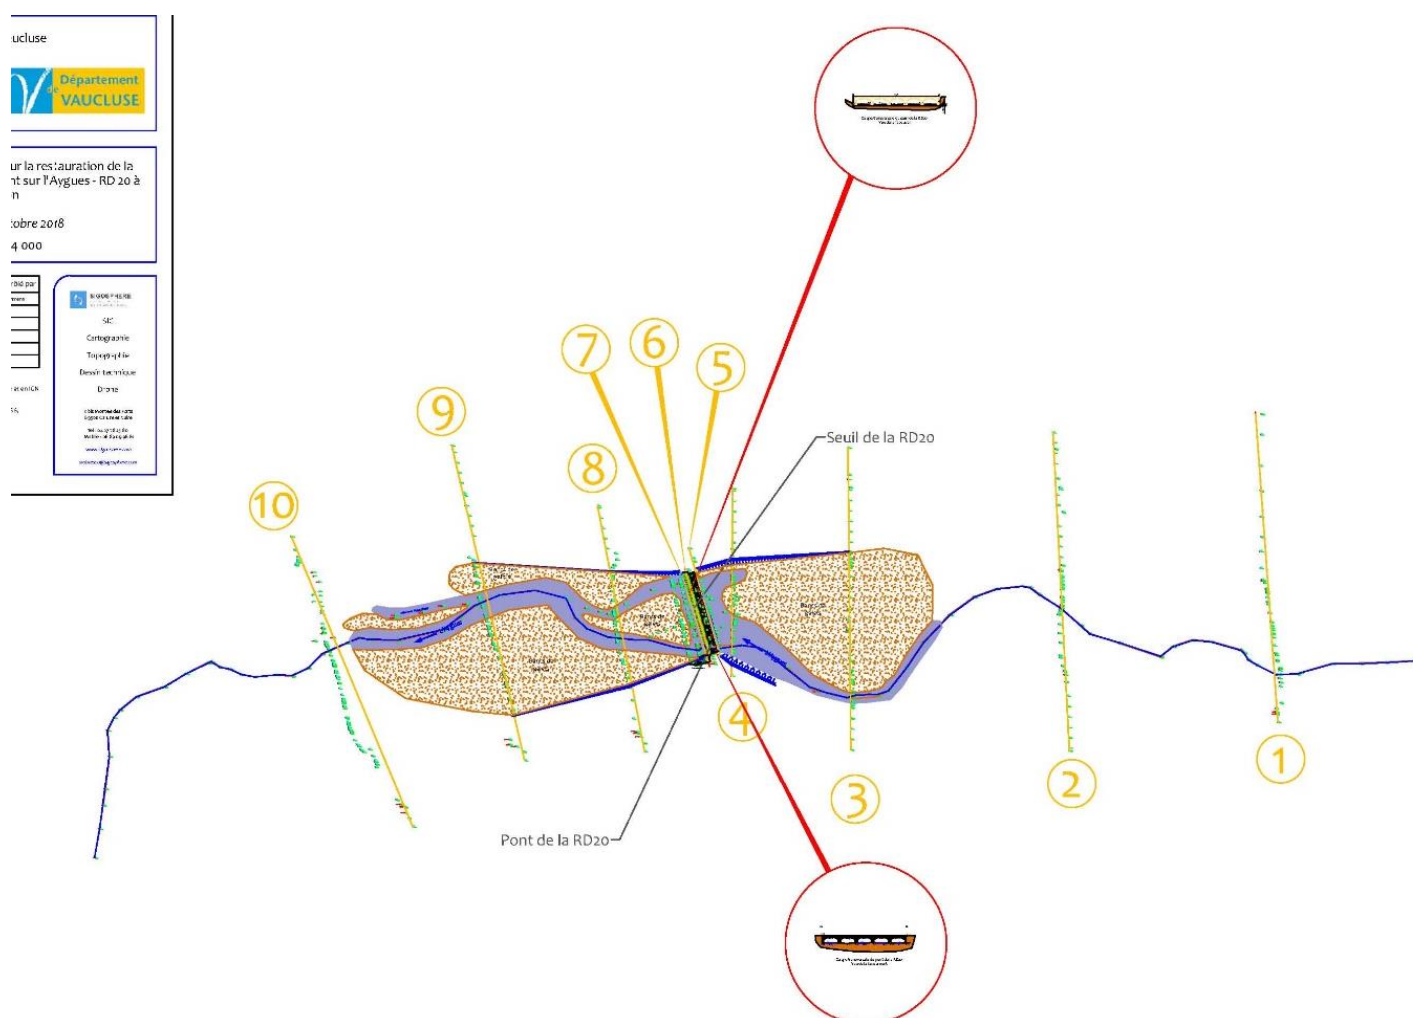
Plan topographique du seuil de la RD 20 à Buisson – Vue générale
